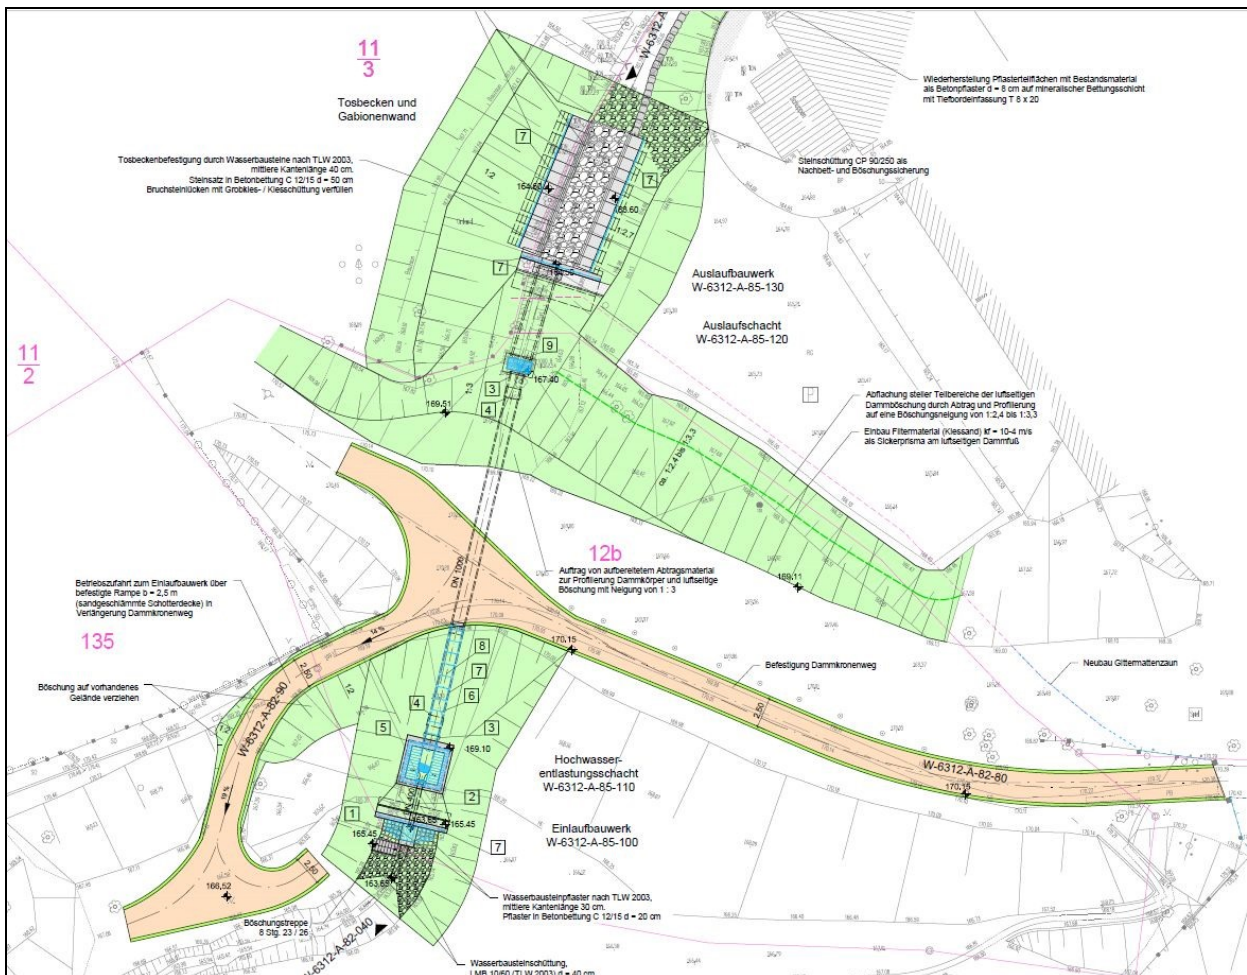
Ausführungsplanung Errichtung Hochwasserrückhaltebecken - Lageplan, 30.06.2016
